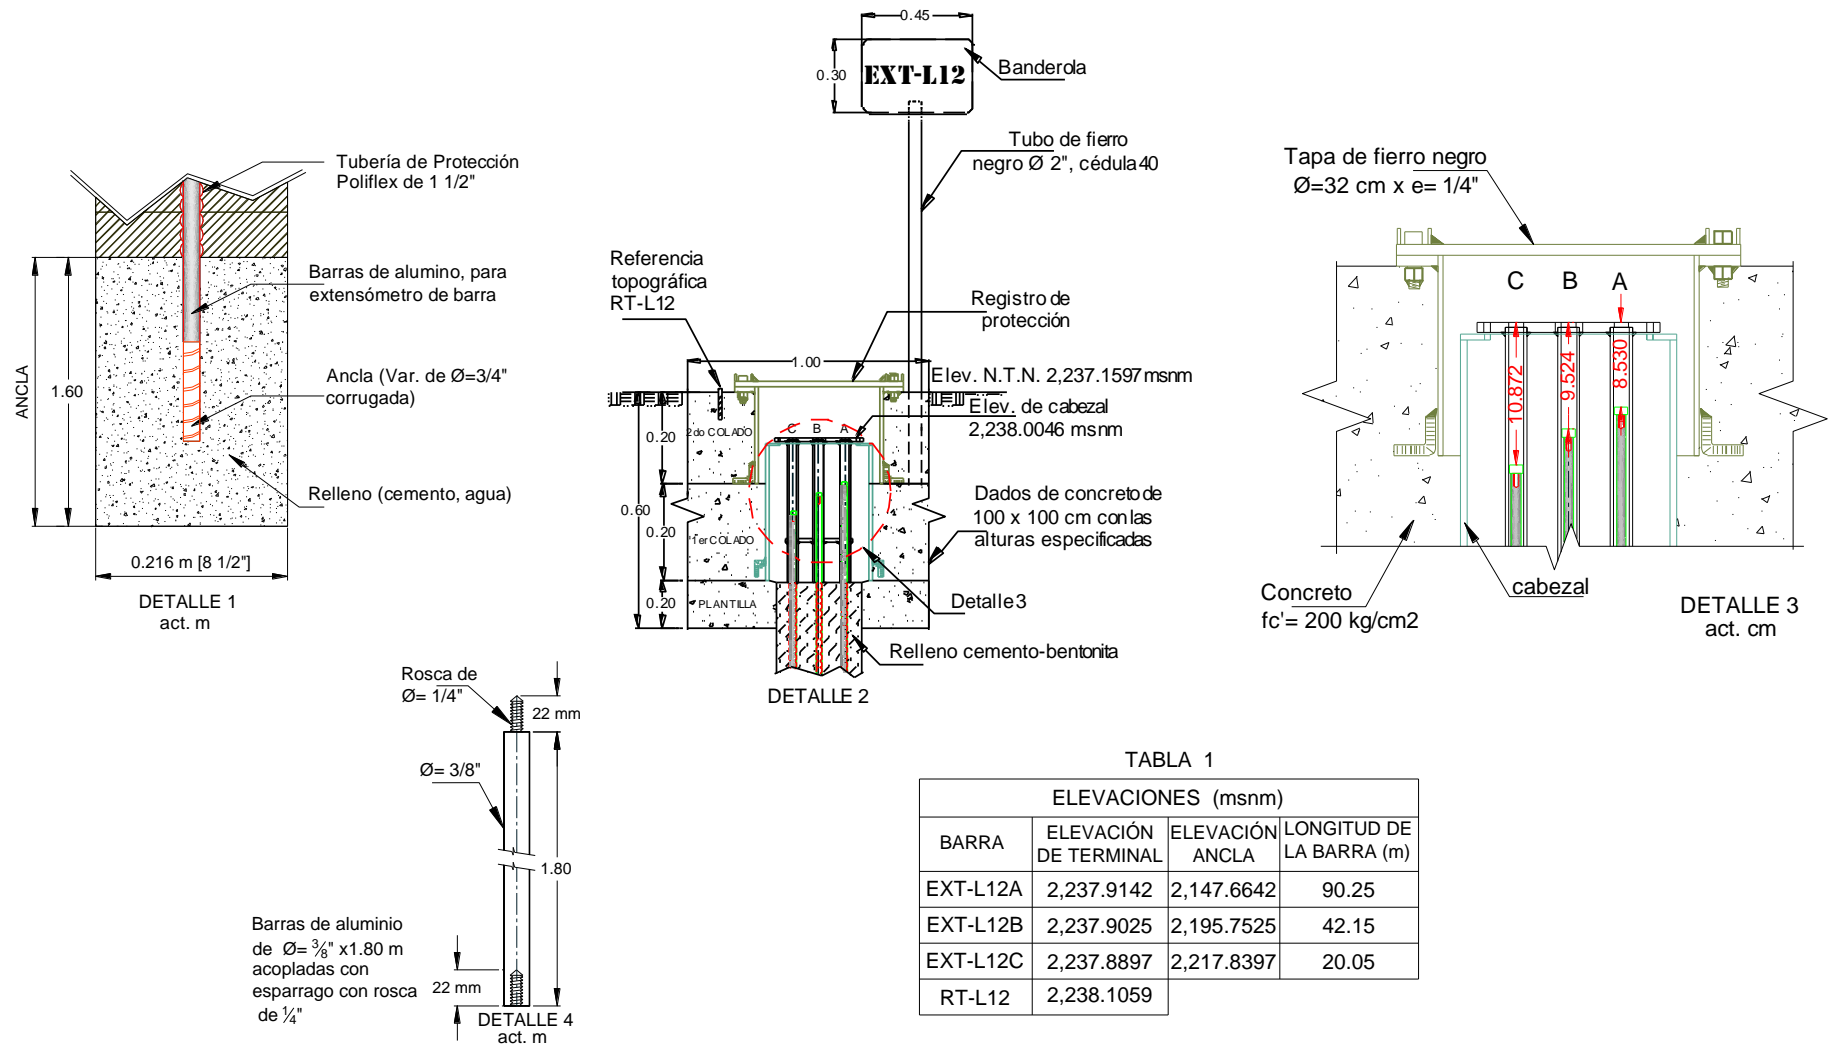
Diseño de extensómetro de barras con 3 anclas para la lumbrera L-12 y detalles constructivos (Fuente: CONAGUA-CFE, 2008).
